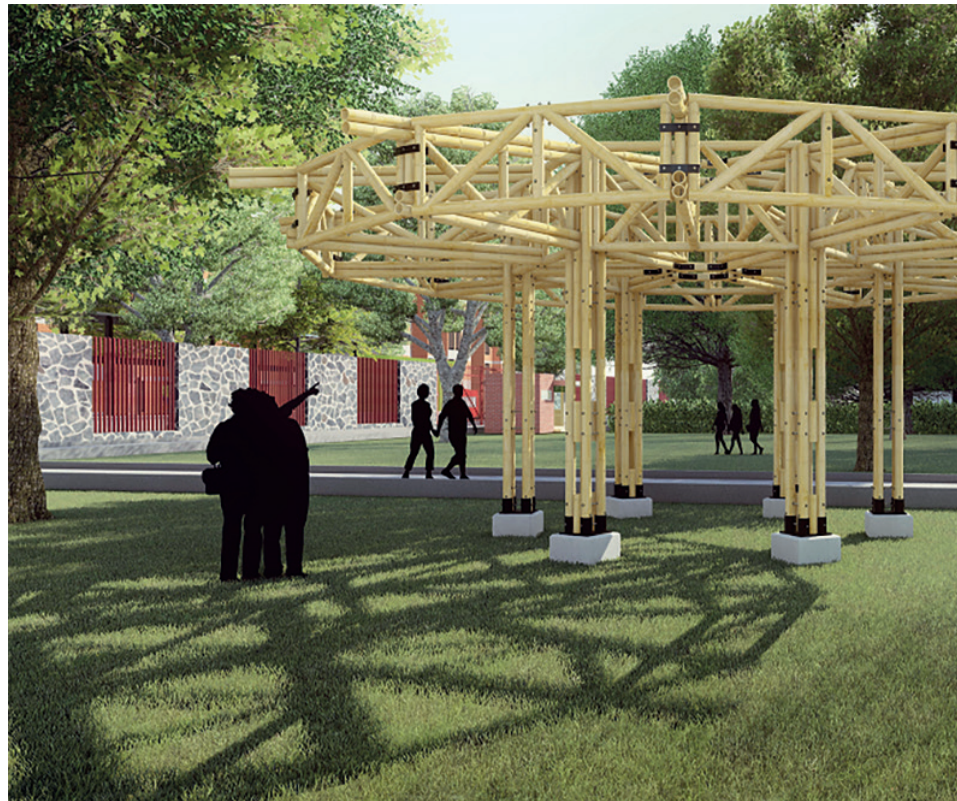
Kiosco a base de armaduras moduladas con bambú.
